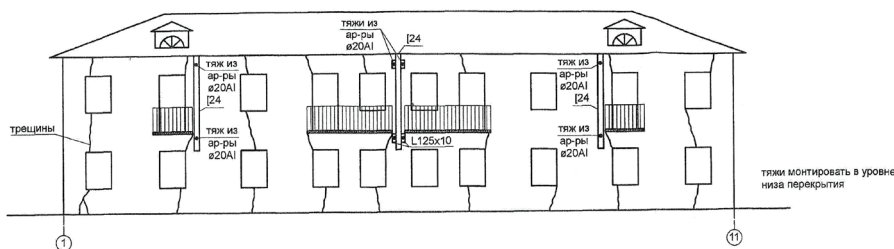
Стена главного фасада, ориентированная по оси «А». Схема расположения трещин и элементов усиления стены (составлена подрядчиком)
